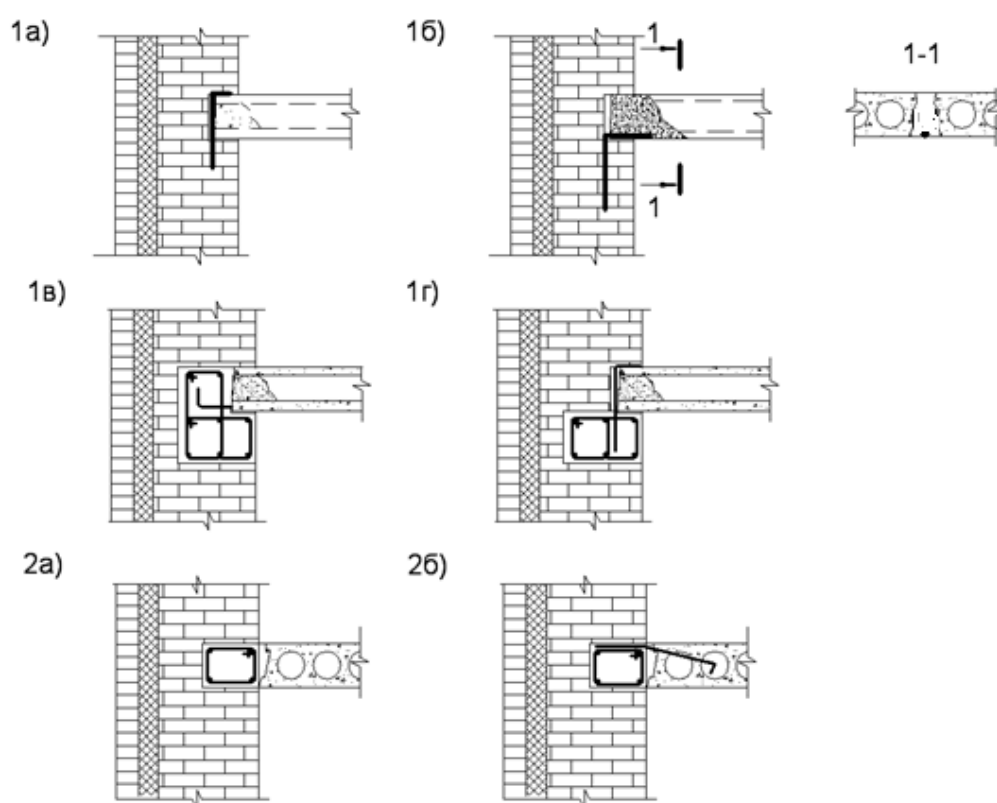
Варианты укладки дополнительной арматуры с увеличенным защитным слоем
